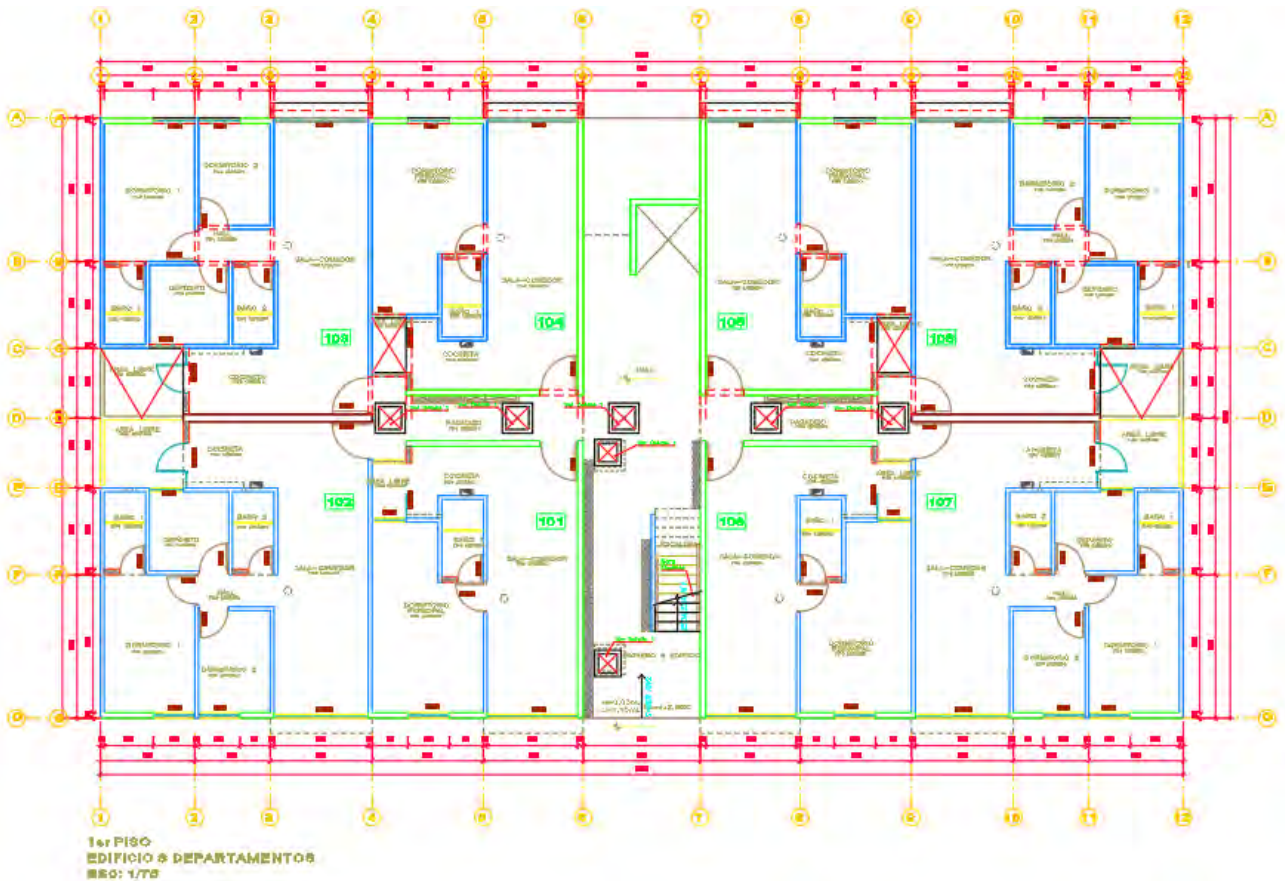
Planta General Proyecto Remanso Los Incas- Fuente: Empresa Privada
